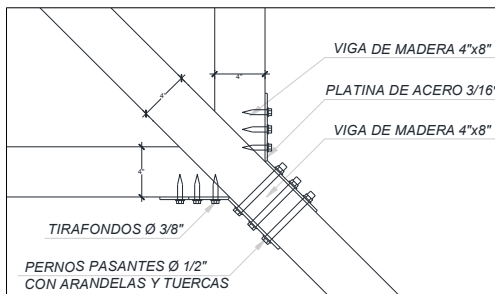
ESTRUCTURA DEL TECHO DE VIVIENDAS
